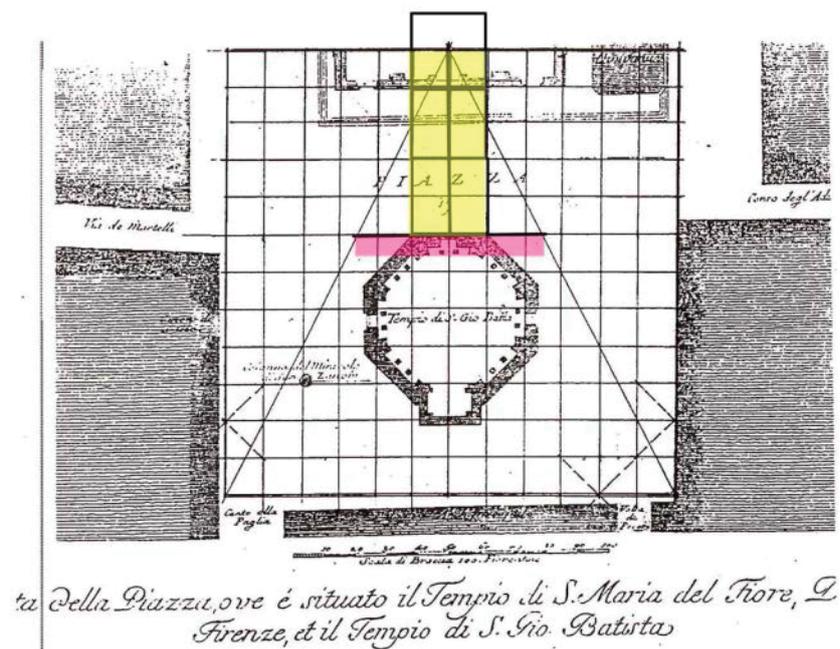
Planimetria della situazione prospettica della Tavoletta nella piazza del Duomo di Giovan Battista Nelli, secolo XVII.
